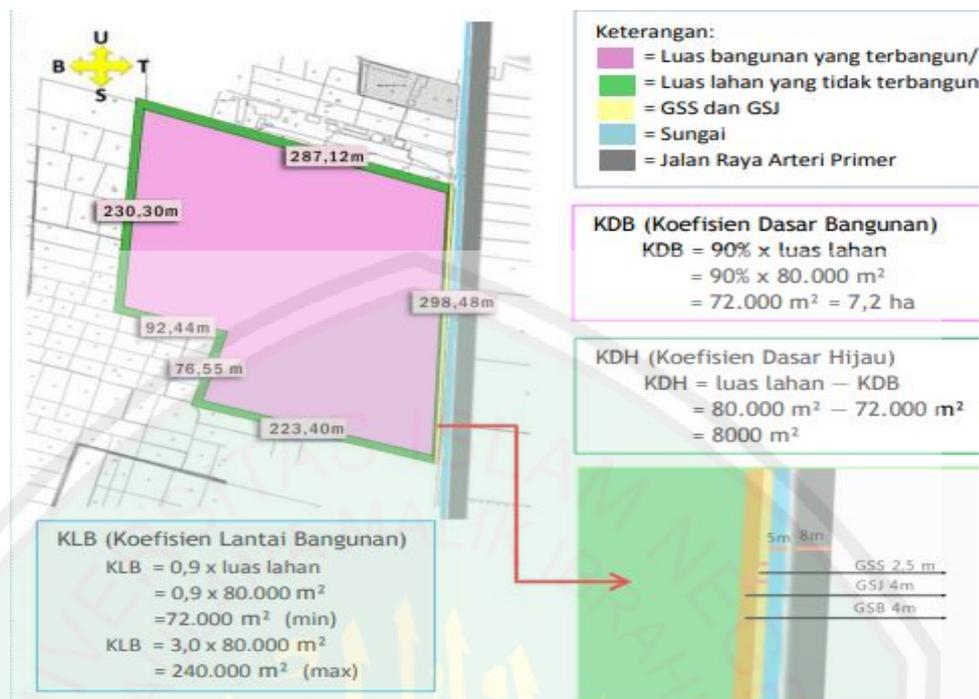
Blok Plan Asrama Haji Terpadu Kota Malang
